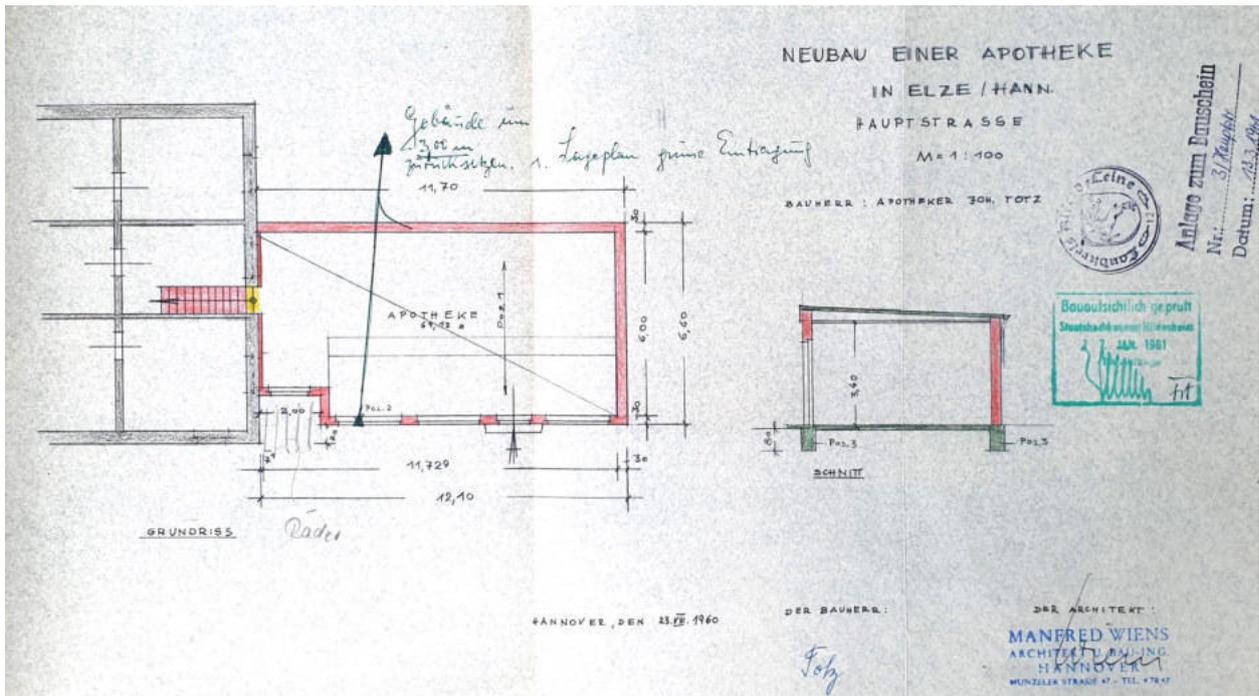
Planzeichnung für den Anbau eines eingeschossigen Flachbaus für ein Ladengeschäft der Apotheke an die Südfassade des Altbaus, 1960 (nicht ausgeführt).
